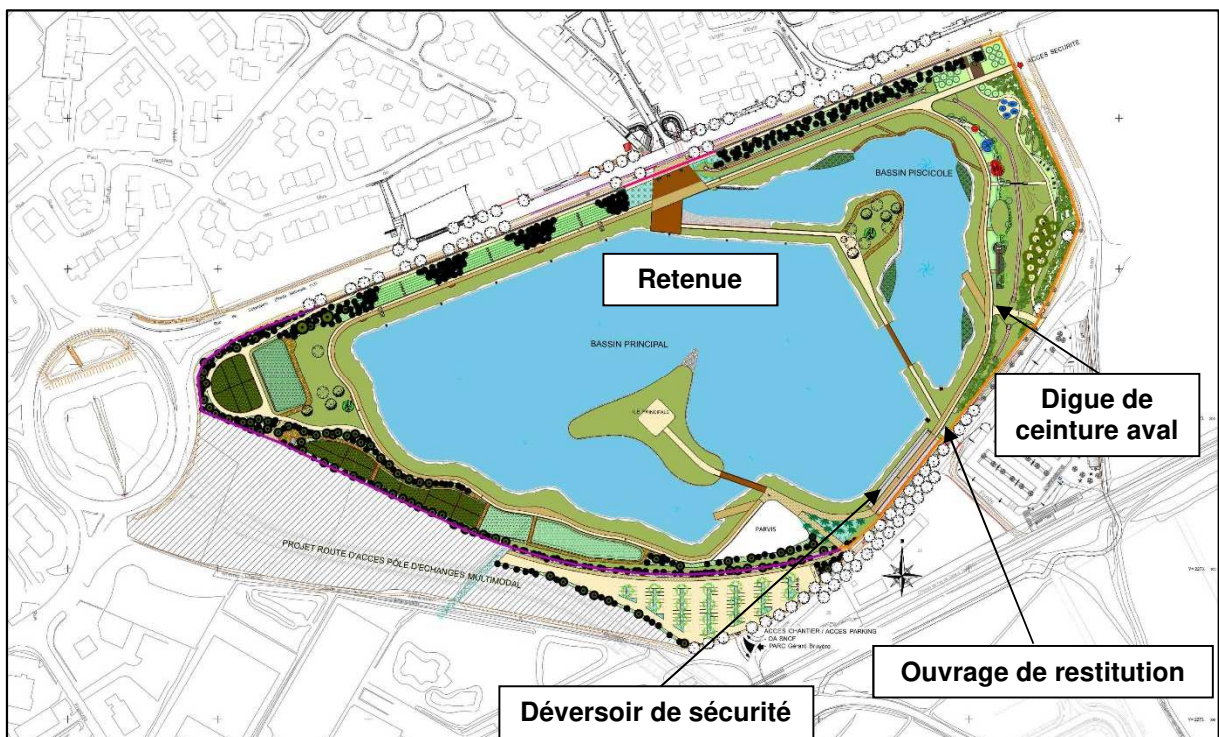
Plan d'aménagement du futur parc Gérard Bruyère
